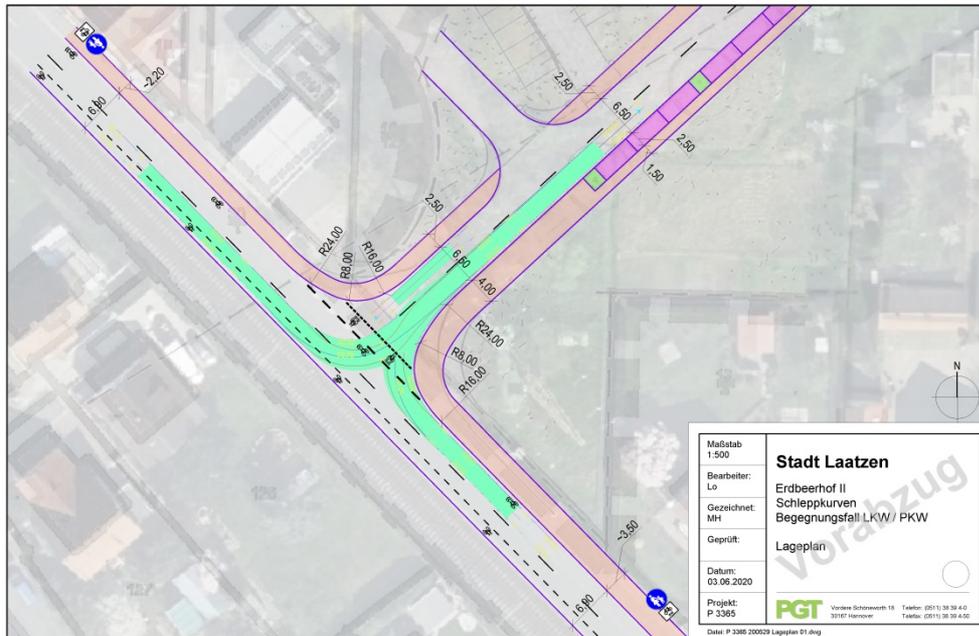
Schleppkurven Knotenpunkt Planstraße A / Hildesheimer Straße
